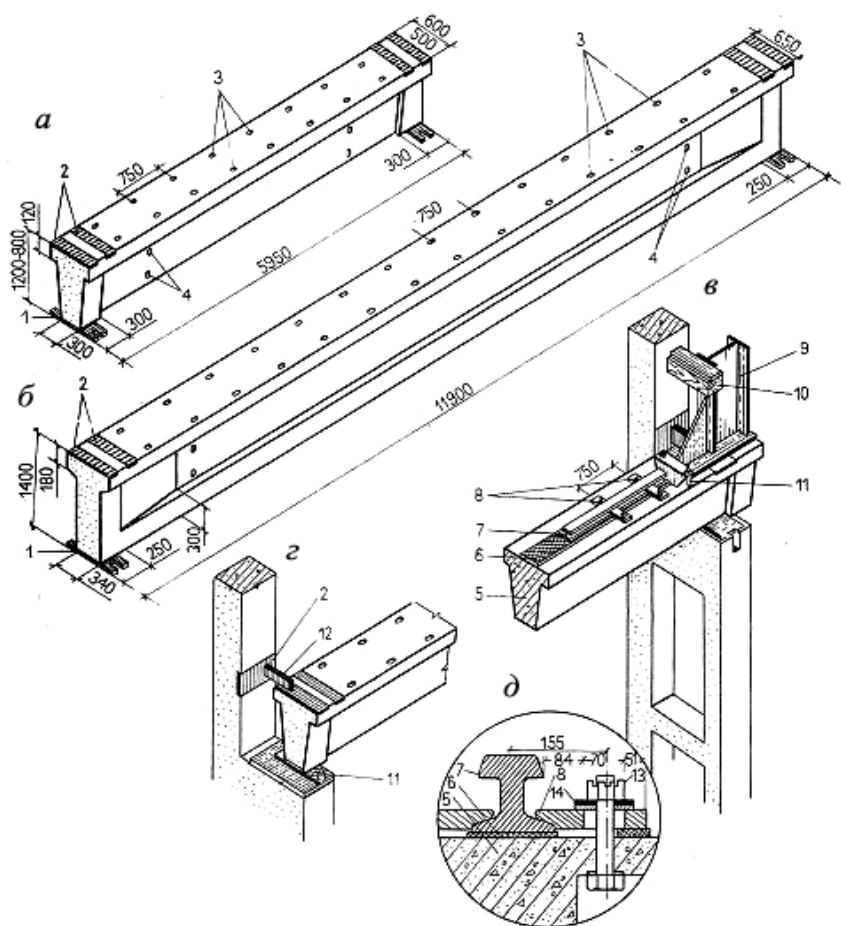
Железобетонные подкрановые балки: а - таврового сечения для шага 6 м; б - двутаврового сечения для шага 12 м; в - концевой упор на балке; г - опирание на колонну; д - крепление кранового рельса; 1 - стальной опорный лист; 2 - закладные детали; 3 - отверстия диаметром 20 мм для крепления рельсов; 4 - отверстия диаметром 25 мм; 5 - подкрановая балка; 6 - упругая подкладка; 7 - крановый рельс; 8 - прижимные «лапки»; 9 - стальной упор; 10 - тормозной брус; 11 - болт; 12 - стальная накладка; 13 - гайка со шплинтом; 14 - шайба
